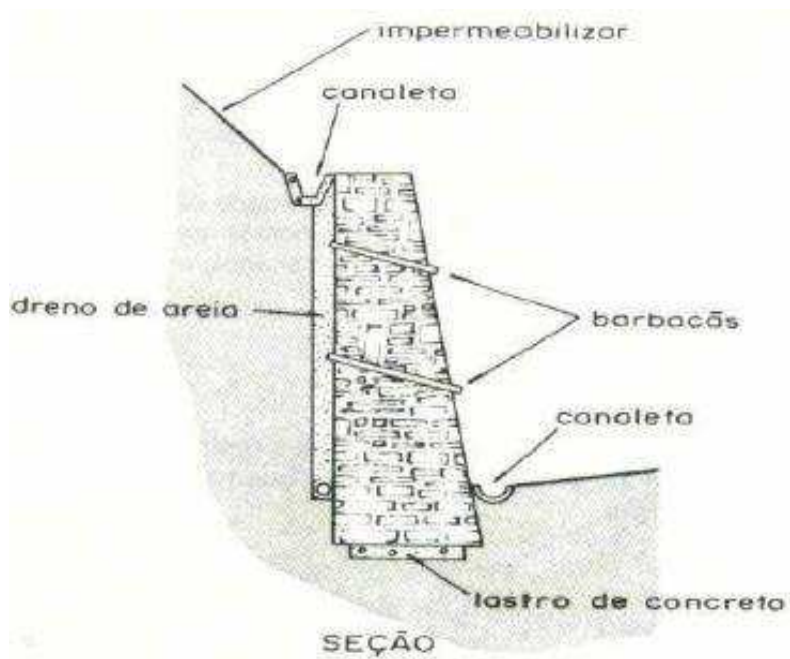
Muro de pedra argamassada. Fonte: CUNHA (1991).
